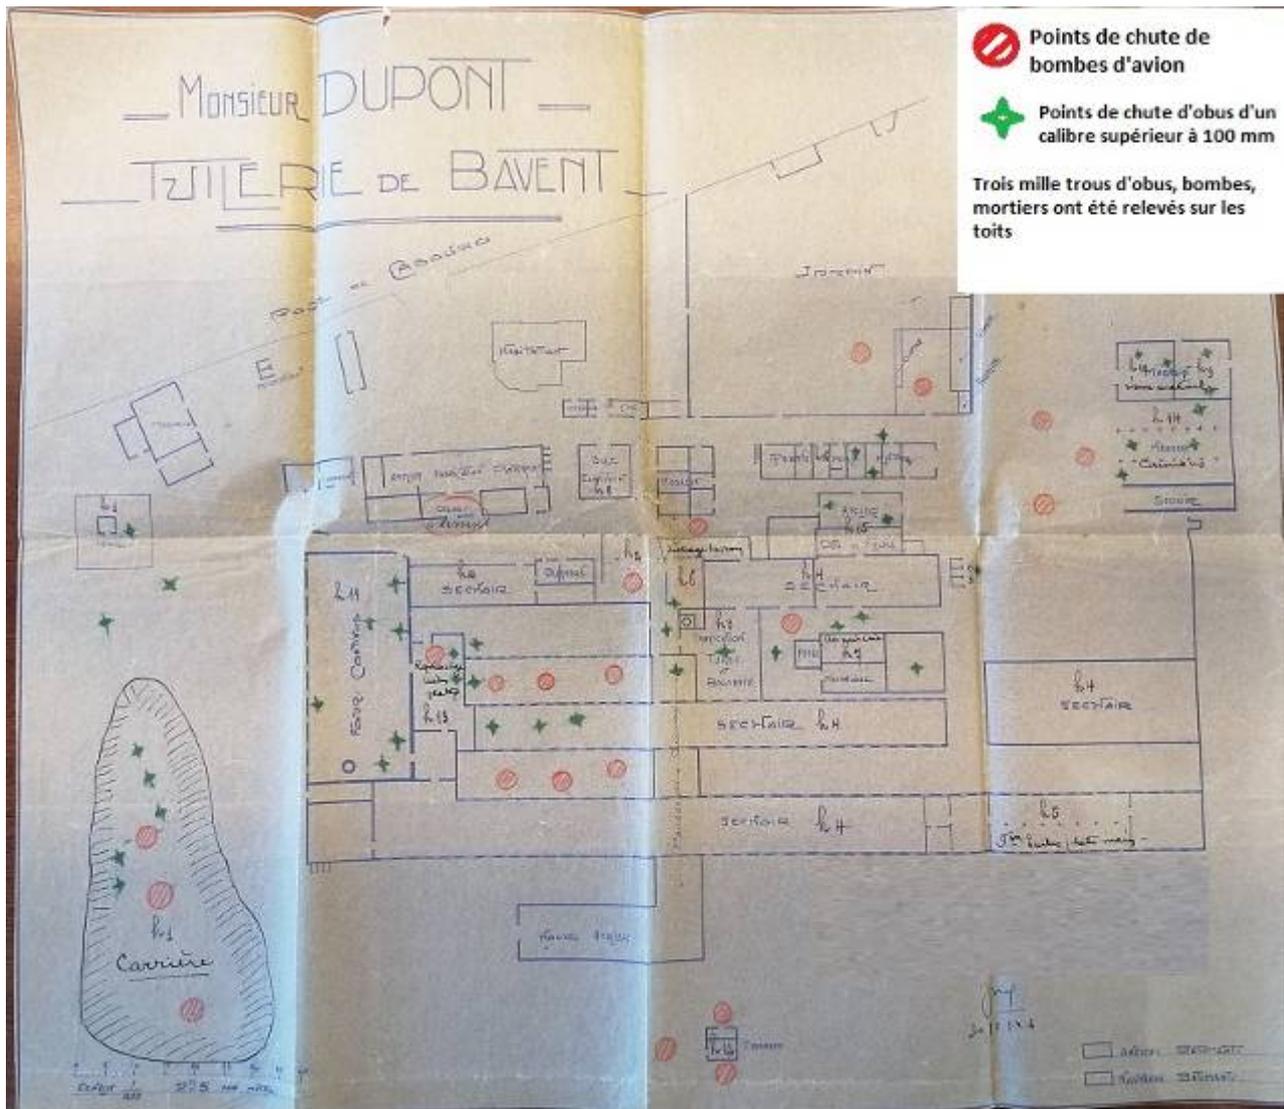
AD14 RIC - plan de la tuilerie et points d'impacts
